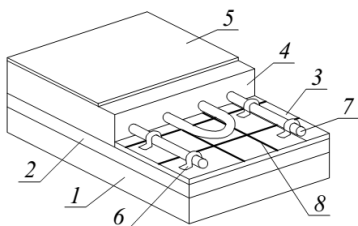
Мокрая укладка с использованием пружинных зажимов: 1 – несущее перекрытие; 2 – тепловая изоляция; 3 – краевая пленка; 4 – монолитный пол; 5 – напольное покрытие; 6 – пружинный зажим; 7 – труба; 8 – проволочная решетка
